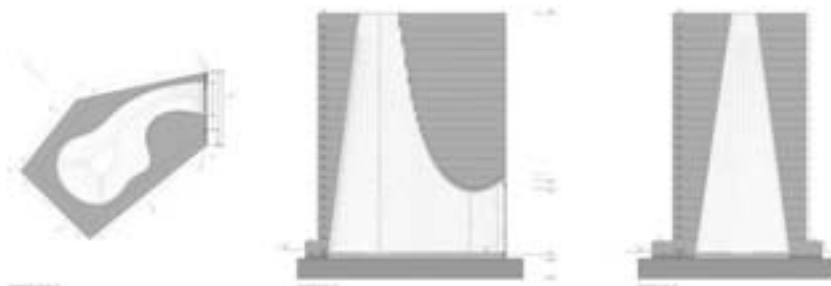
Querschnitte und Grundriss der Bruder-Klaus-Kapelle. © *Atelier Zumthor, Haldenstein
